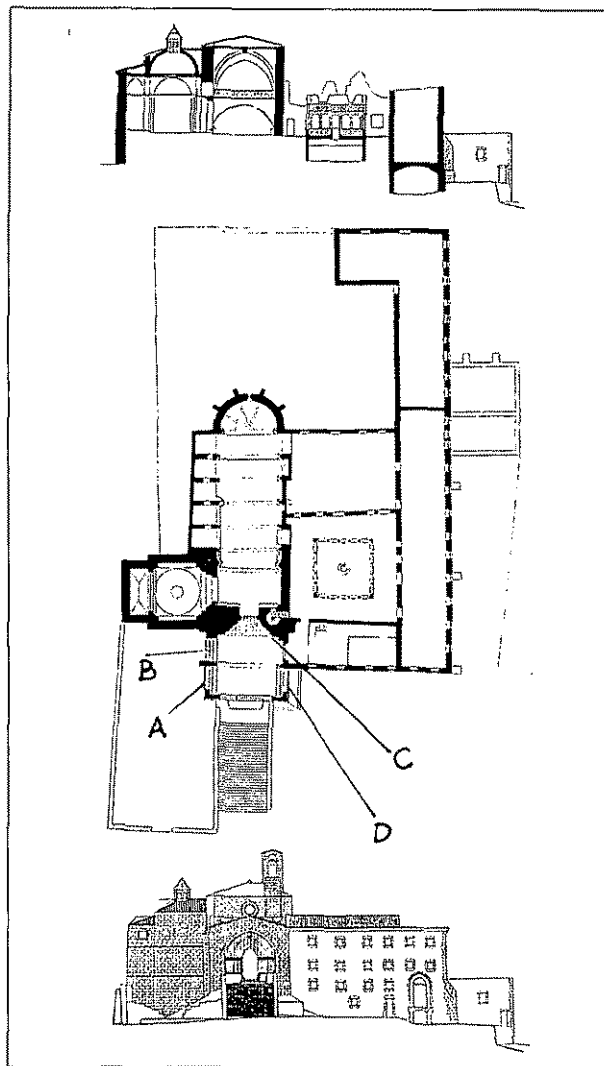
Figura II. Convent de Sant Salvador. Planta i situació dels sarcòfags.
